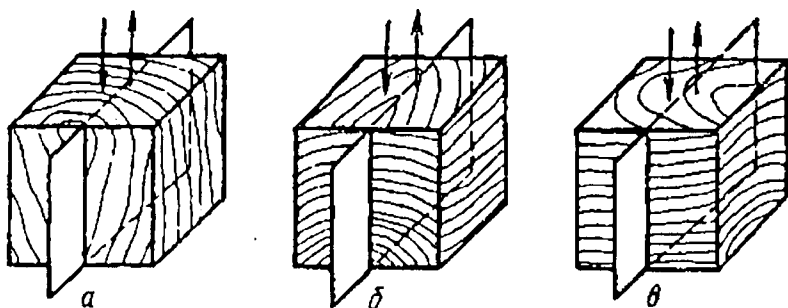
Схемы действия сил при разных видах испытаний древесины на сдвиг: а - скалывание вдоль волокон; б - скалывание поперек волокон; в - перерезание древесины поперек волокон
